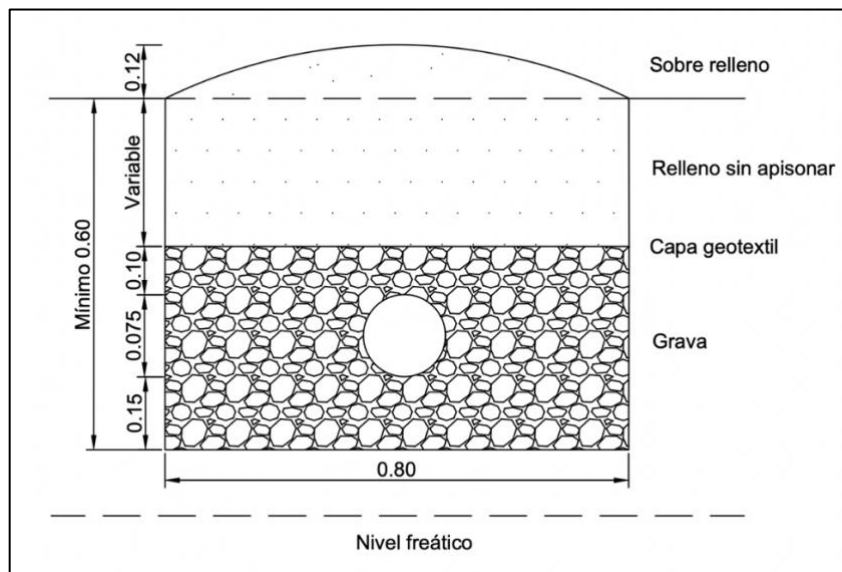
Zanja de infiltración sección transversal. Fuente. Gamboa, 2023.
